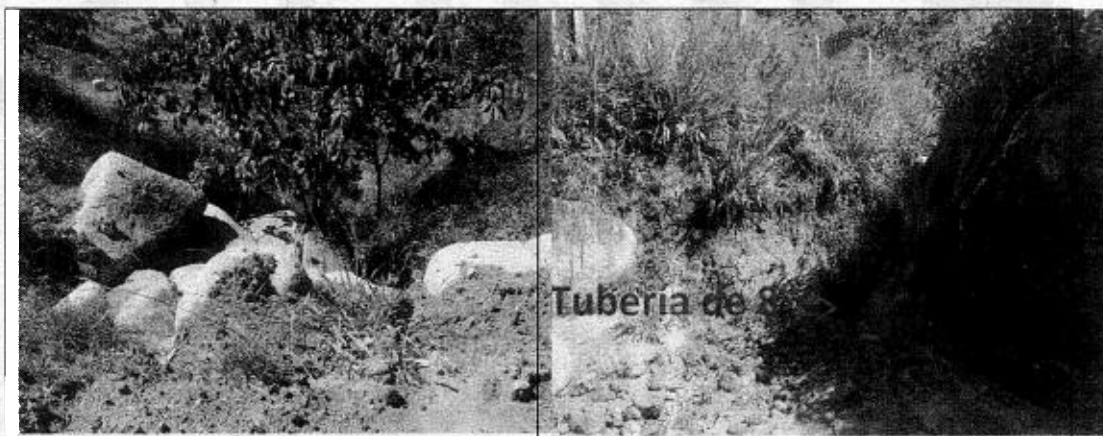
Obra de captación de donde se conduce el recurso hasta los tanques.
